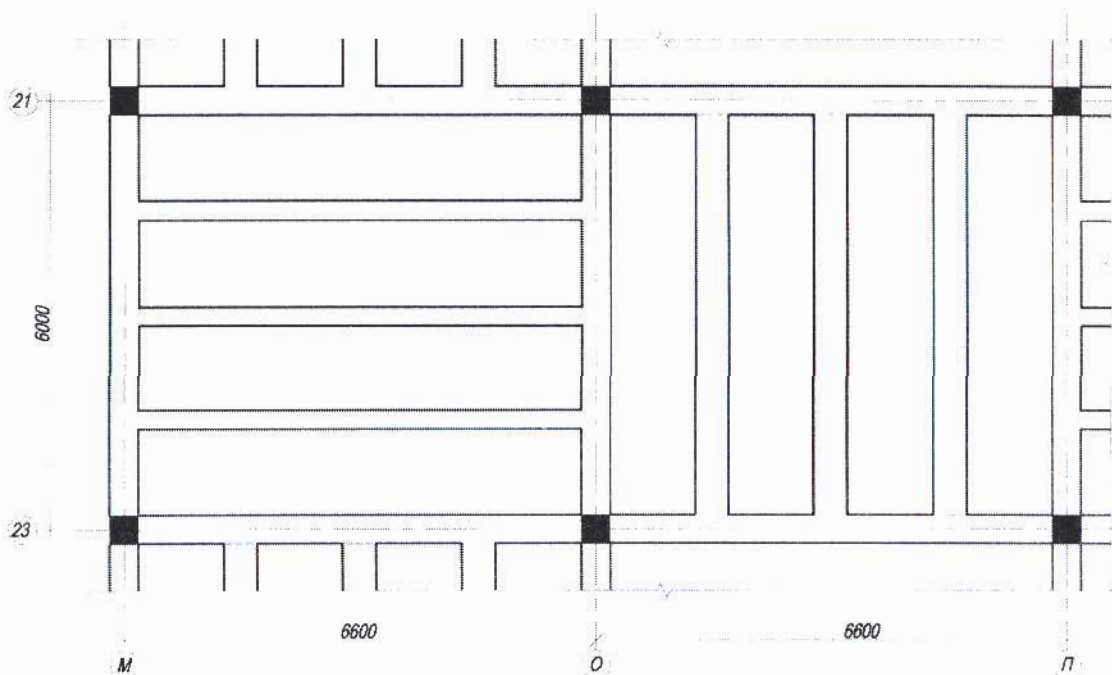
Фрагмент покрытия из двух ячеек (в ячейках покрытия сборные плиты повернуты по нормали к плитам смежных ячеек)
